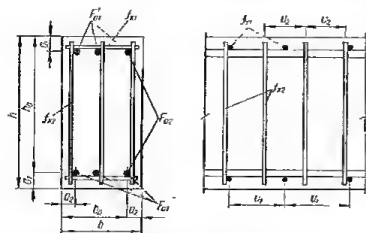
Схема армирования железобетонного элемента, работающего на кручение с изгибом.
